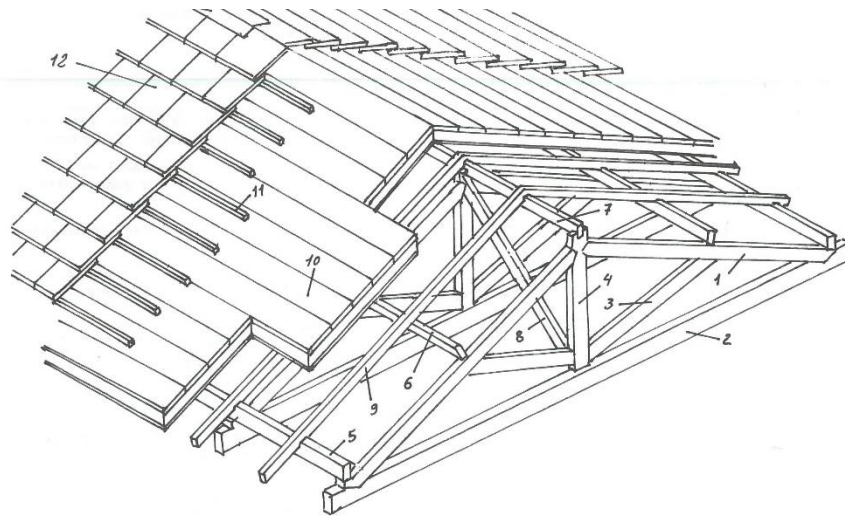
Pormenor Construtivo da Cobertura Inclinada Tradicional: 1-perna; 2-linha, 3-escora; 4-pendural; 5-frechal; 6-madre; 7-fileira; 8-diagonal; 9-vara; 10-guarda-pó; 11-ripado; 12-telha;
